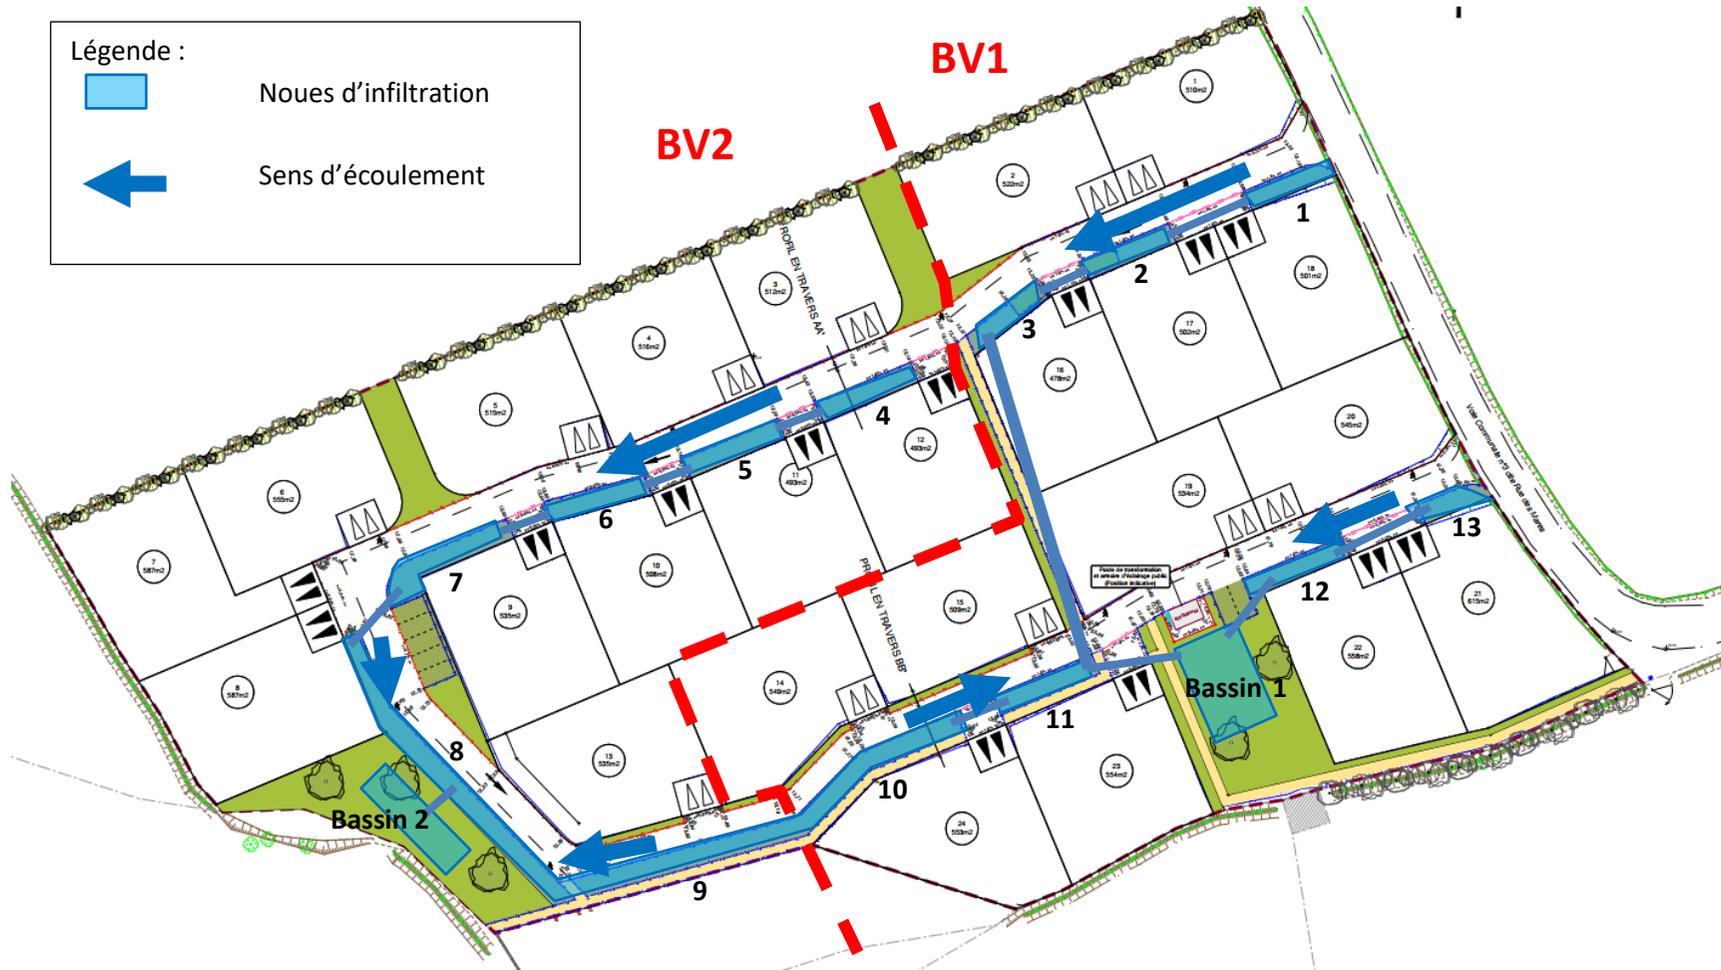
Plan d'implantation de l'ouvrage de gestion des eaux pluviales
